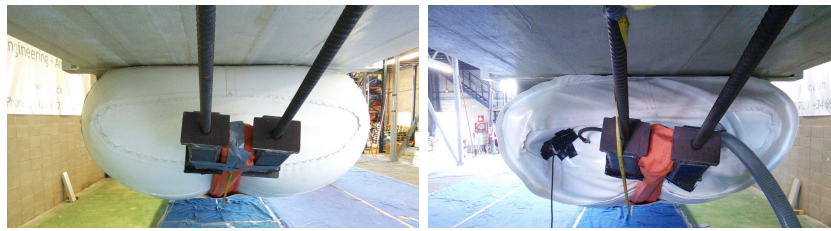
Penetración de la eslinga en el tubo y contacto tubo-tablero de la viga 1 con 8 tn de carga
